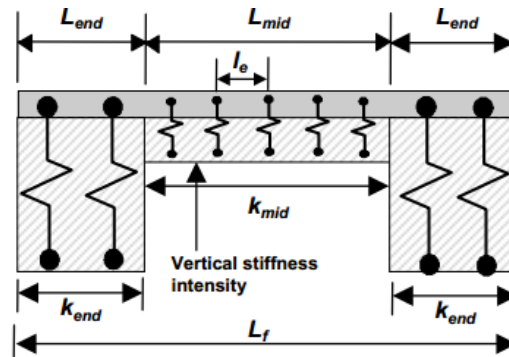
Différentes zones de rigidité pour une semelle de fondation.
